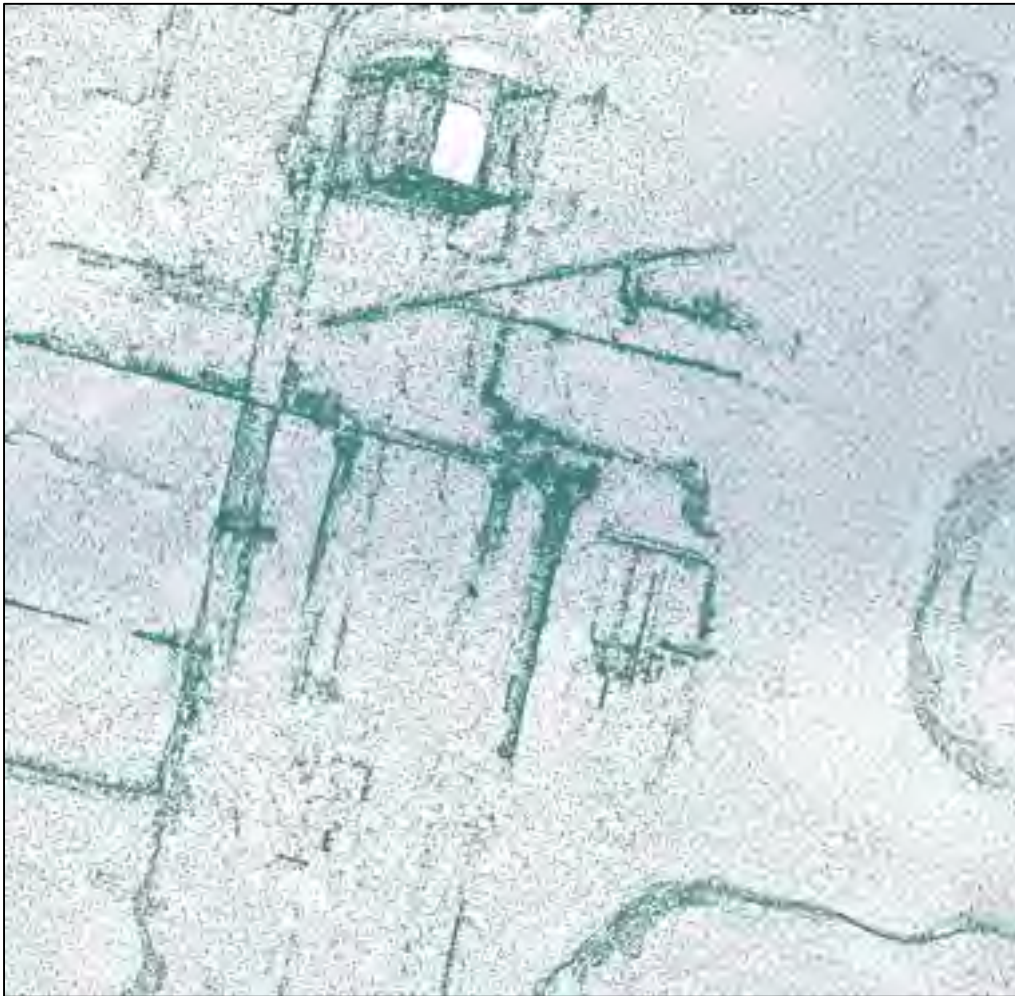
Nuage de points relevé par photogrammétrie (vue du dessous)
